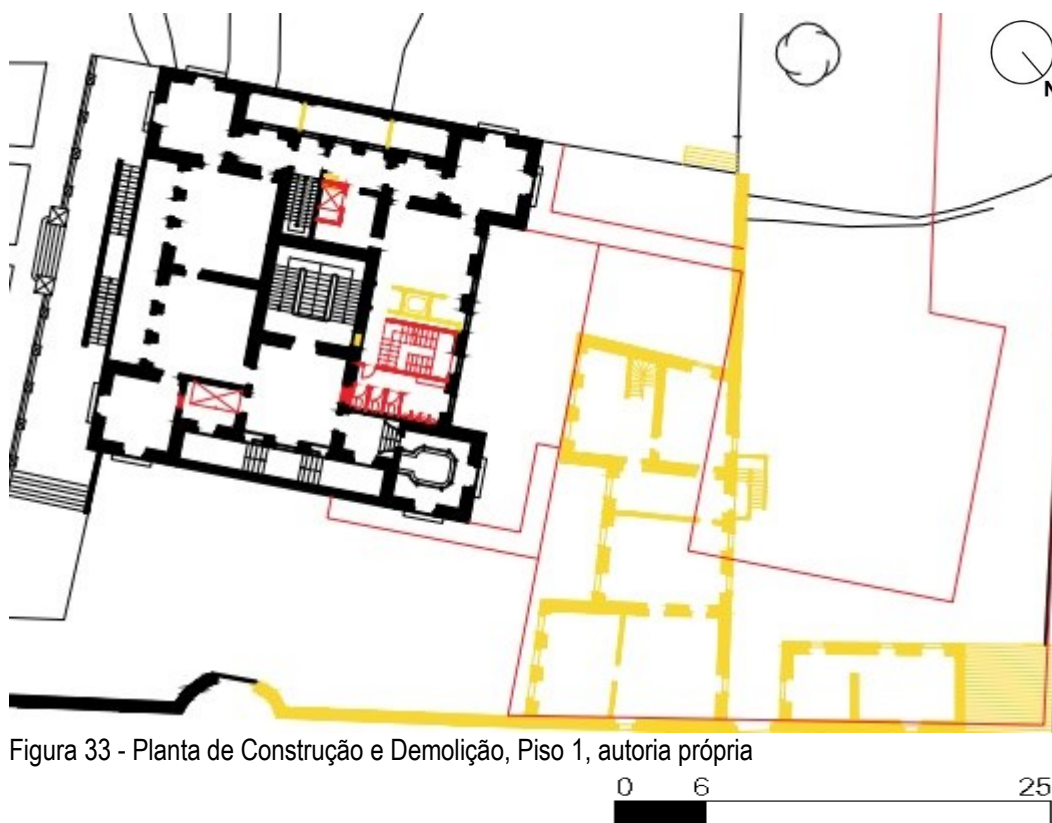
Planta de Construção e Demolição, Piso 1, autoria própria
